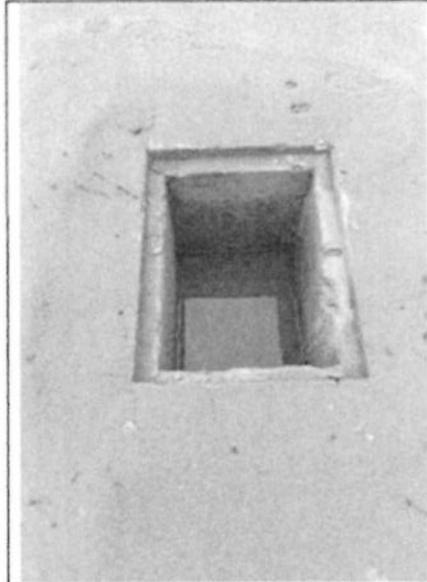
Se observó enchapado incompleto en muros de drywall, en los cuales no se encontró personal trabajando.
